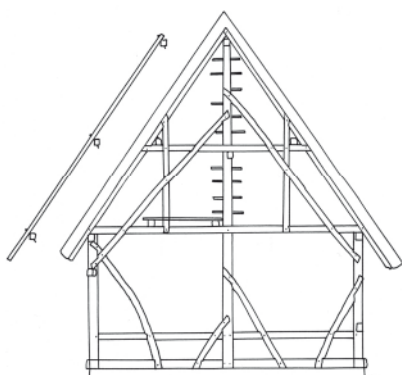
Scheune, Querschnitt durch die Tenne. Die Konstruktion von Fachwerk und Dachkonstruktion entspricht als „Firstständerbau“ weitestgehend jener des Bauernhauses. Der Erdgeschossbereich öffnet sich frei in den Dachraum hinein (Zeichnung: B. Lohrum; Maßstab ca. 1:220).
